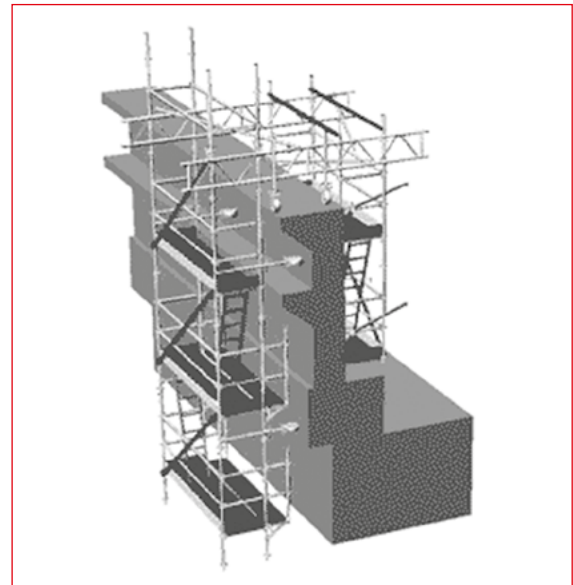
Способ монтажа подвесных строительных лесов
